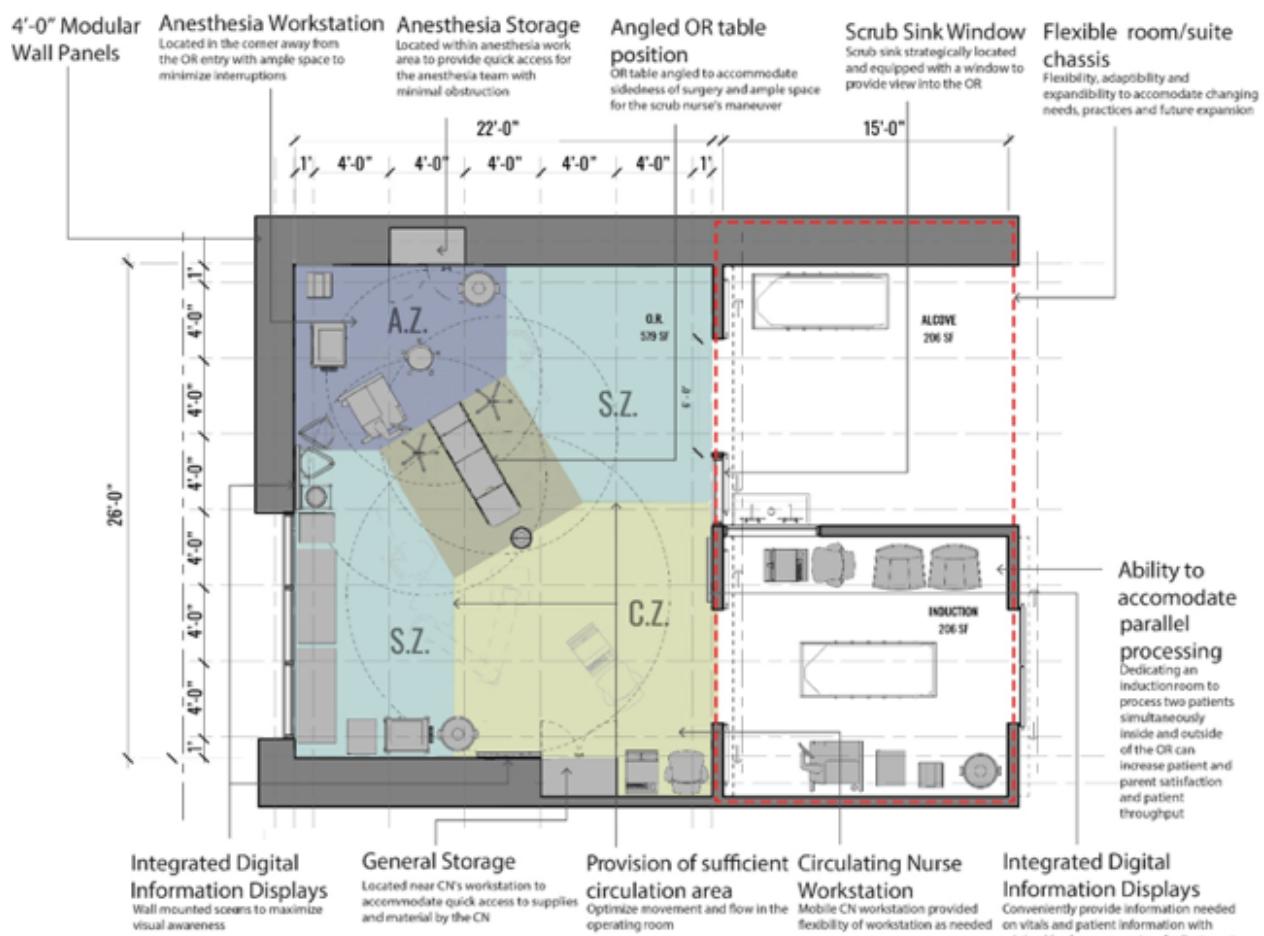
Planta baixa do protótipo final da sala de cirurgia.
